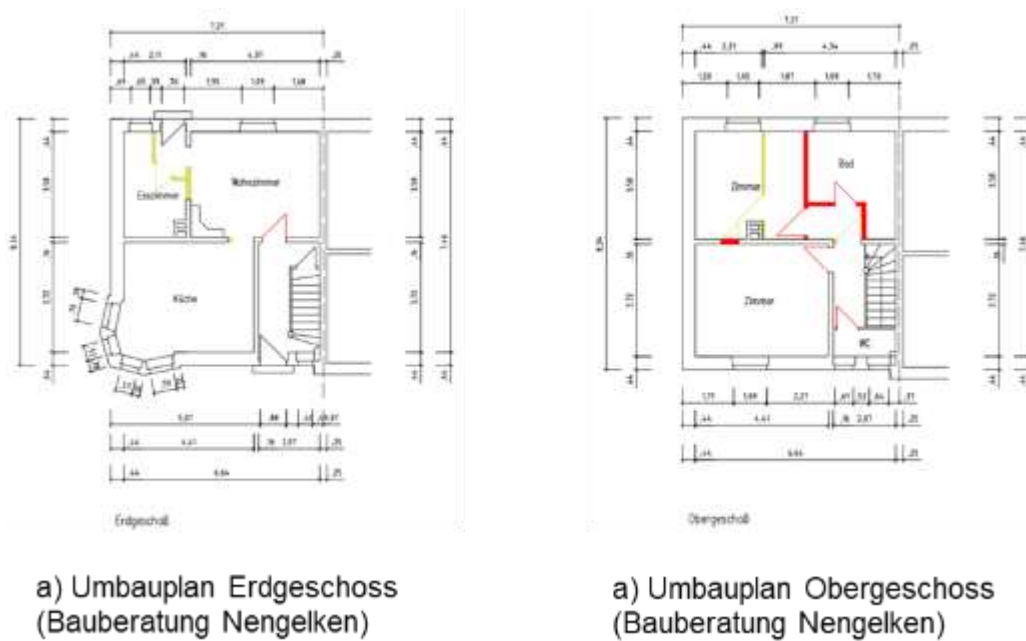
Grundrisse der Metzendorfstraße 38 C in den Varianten „Ist-Zustand“ und „Sanierung“.
